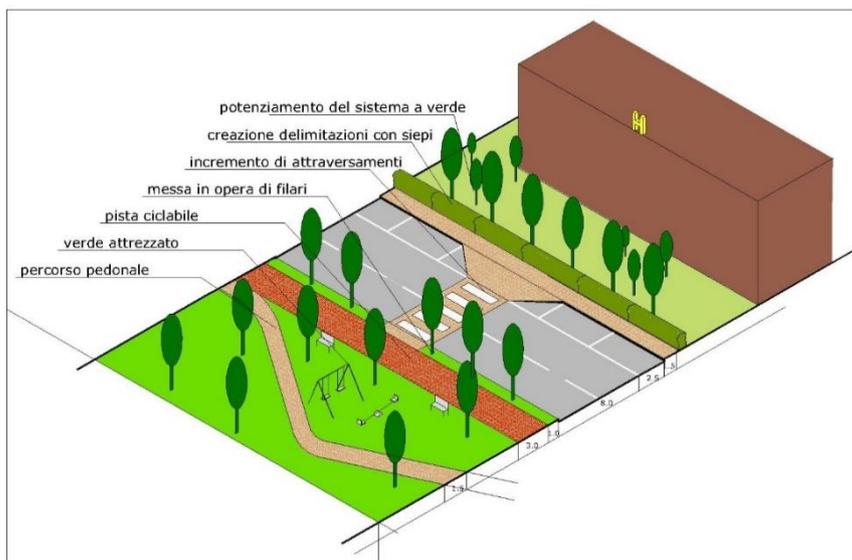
Rappresentazione schematica stato di progetto sezione 3
